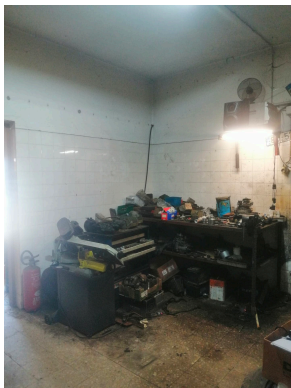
Fotografia do Existente, Arrecadação<sup>4</sup>
